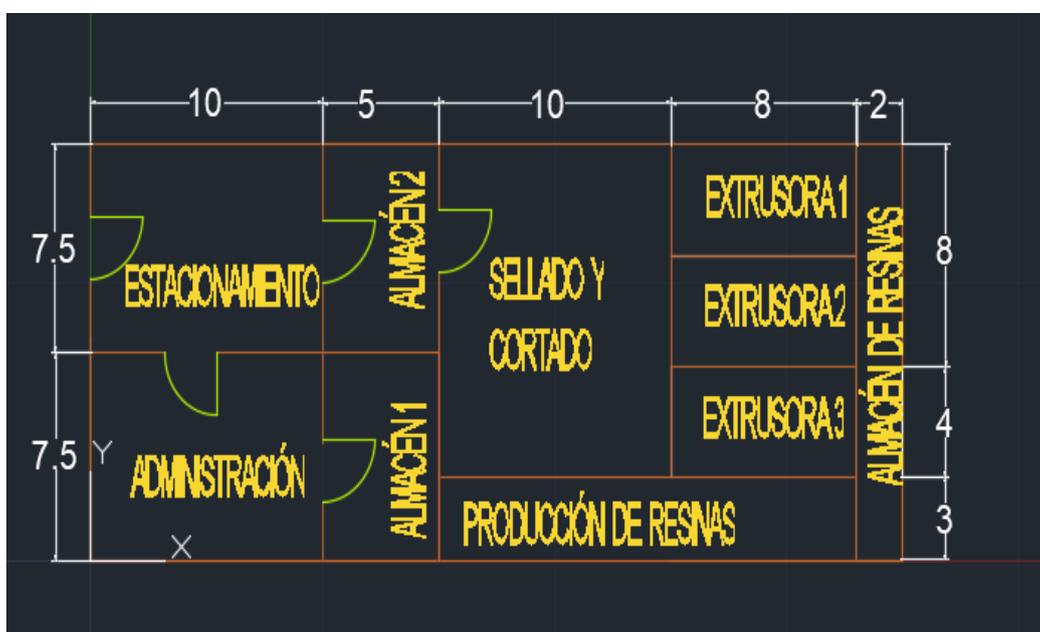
Disposición futura en planta para la empresa Polímeros del Norte S.A.C.
